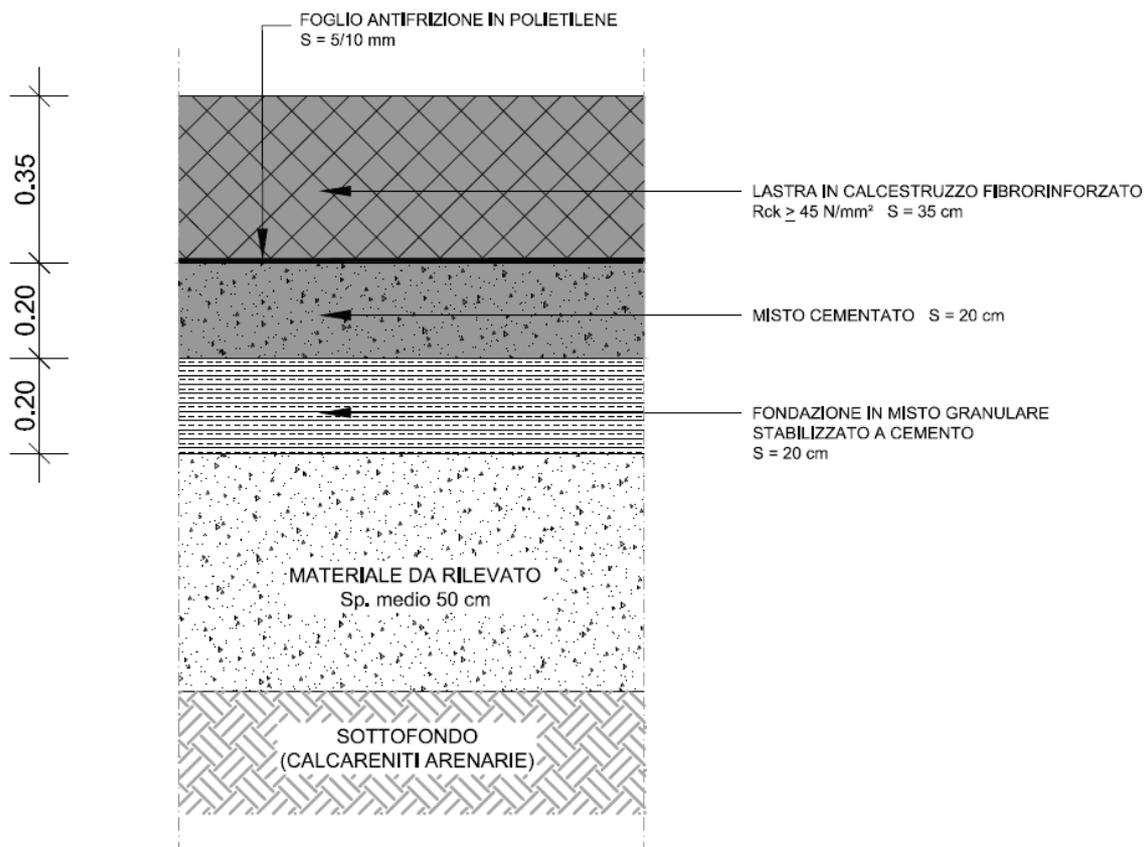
Rappresentazione pavimentazione rigida - Tipologia D
